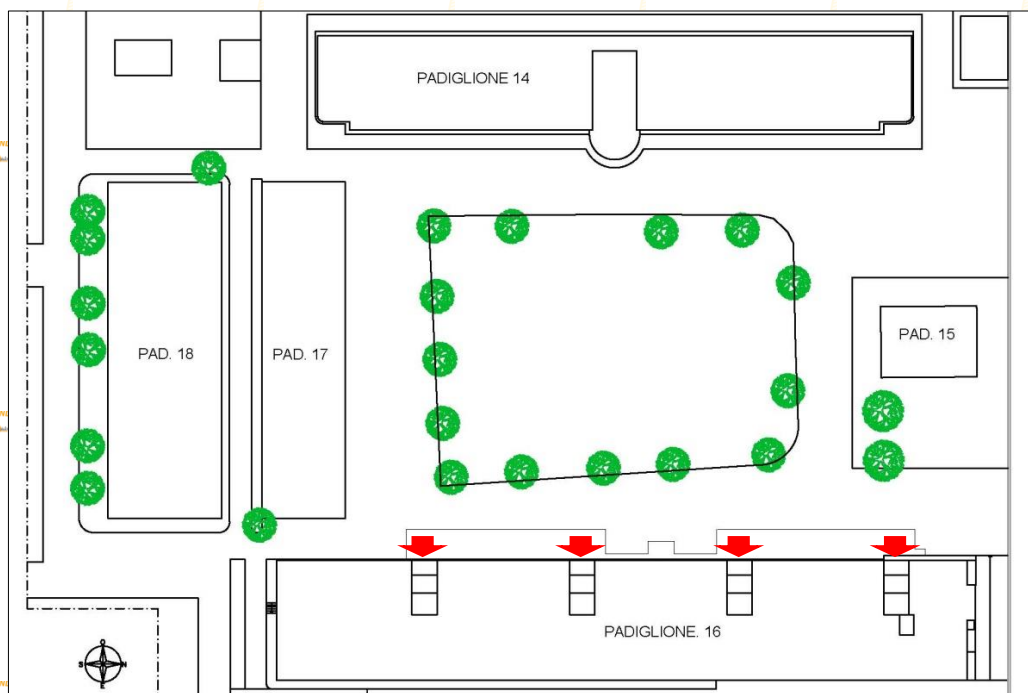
Planimetria stralcio ex Ospedale Bonomo
